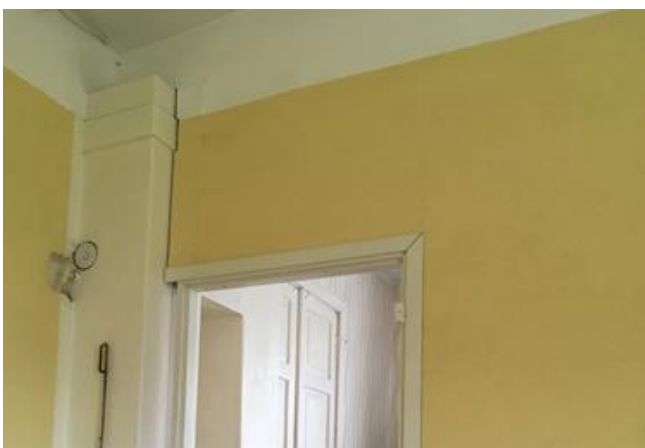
Struktuurkrohvitud seinad (Ruum 16).
